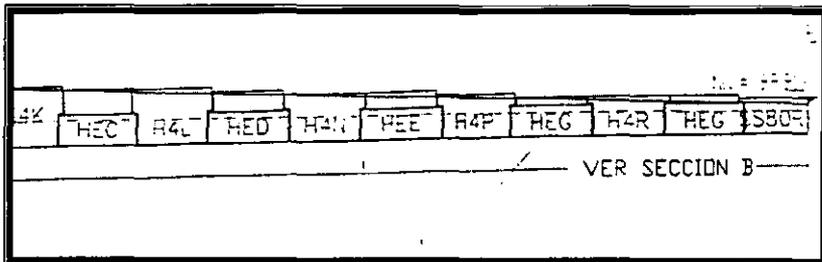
a. Perfil del muro de tierra armada. Inicio de rampa.
